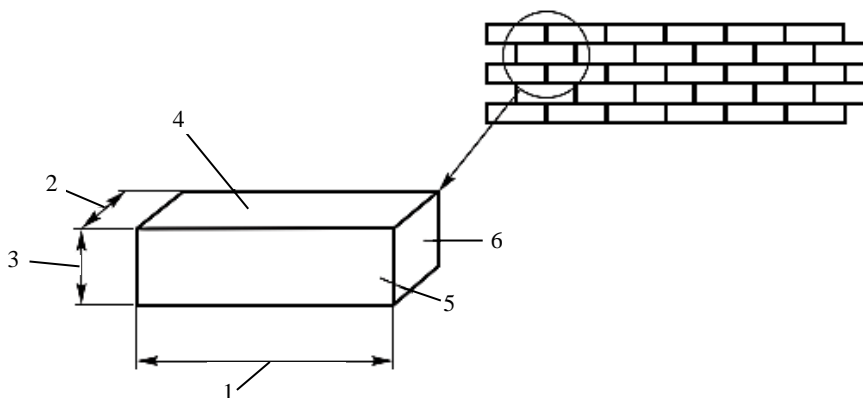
Размеры и поверхности кирпича: 1 — длина; 2 — ширина; 3 — высота; 4 — опорная поверхность; 5 — лицевая поверхность; 6 — торцевая/тычковая поверхность
